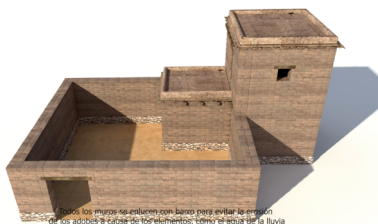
Fotograma del plano general de la estructura con el aparejo visto
